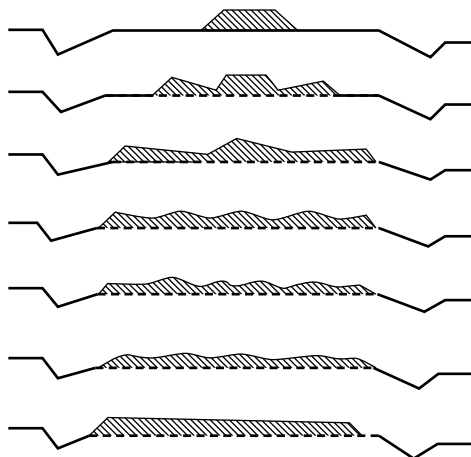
Укрепление грунтового покрытия минеральными материалами
